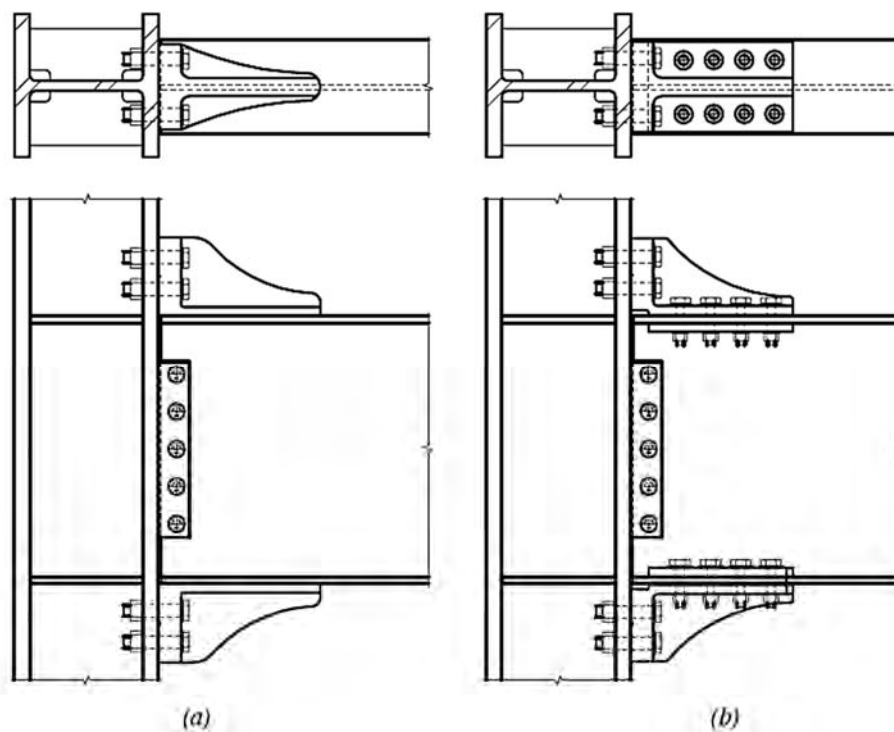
Conexión tipo Kaiser (KBB) a) Soldada a la viga b) Atornillada a la viga (AISC 358-16 2016).
